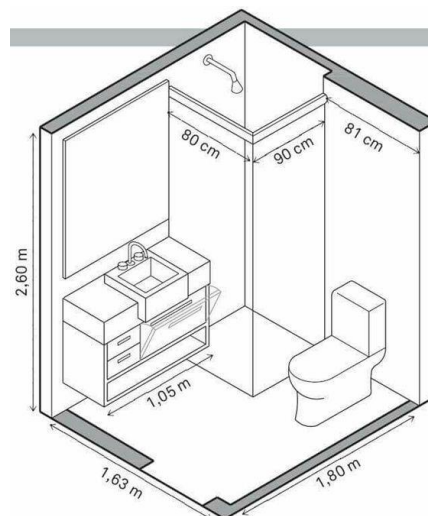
Axonometría de distribución en baño para tiny house / baño en seco. Fuente: *Ideal tiny*, 2024
